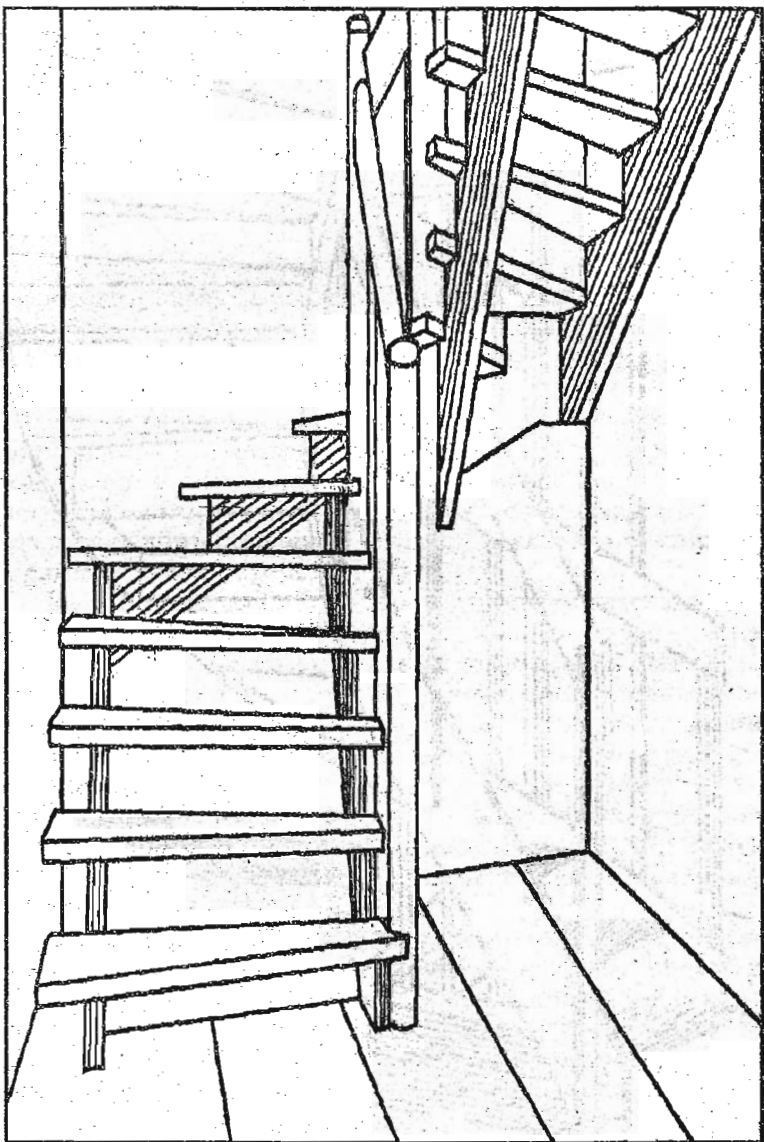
Лестница с забежными ступенями вместо промежуточной площадки.
